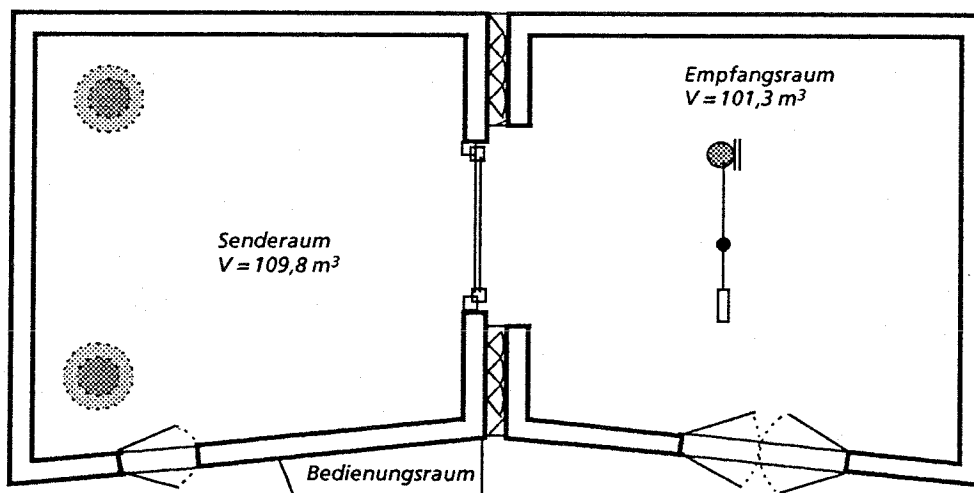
Prüfstand für Fenster und Scheiben mit eingebautem Probekörper (Grundriß)
